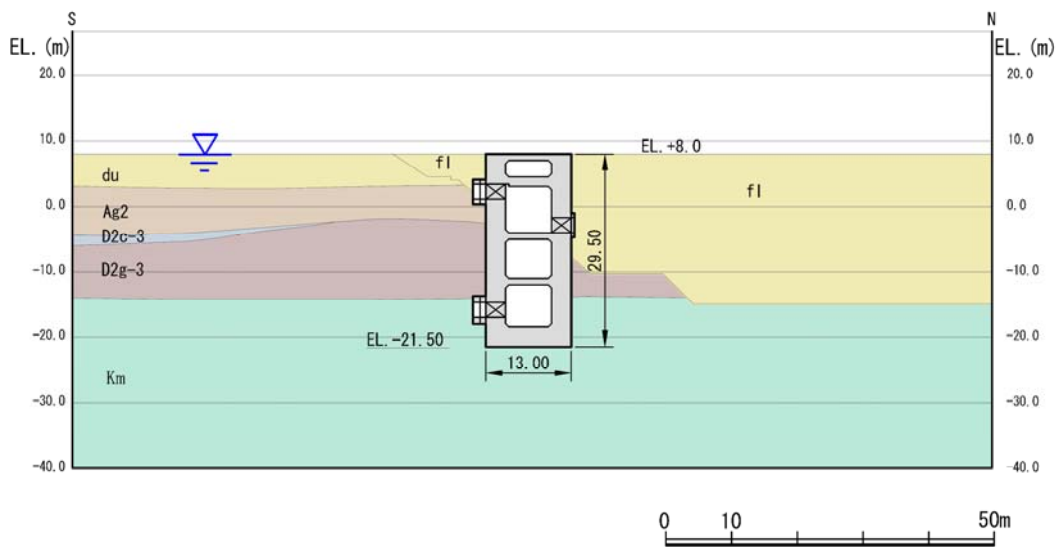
(10) 常設低圧代替注水系ポンプ室評価対象断面図 (南北方向断面)
